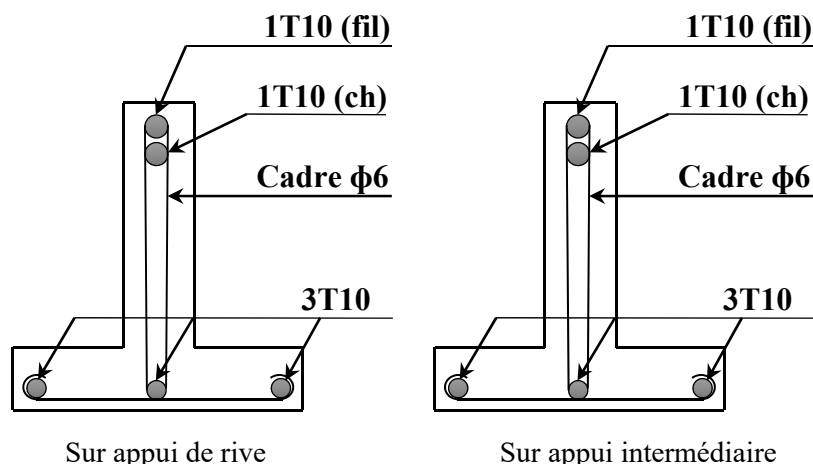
Dessin de ferrailage des poutrelles de terrasse
